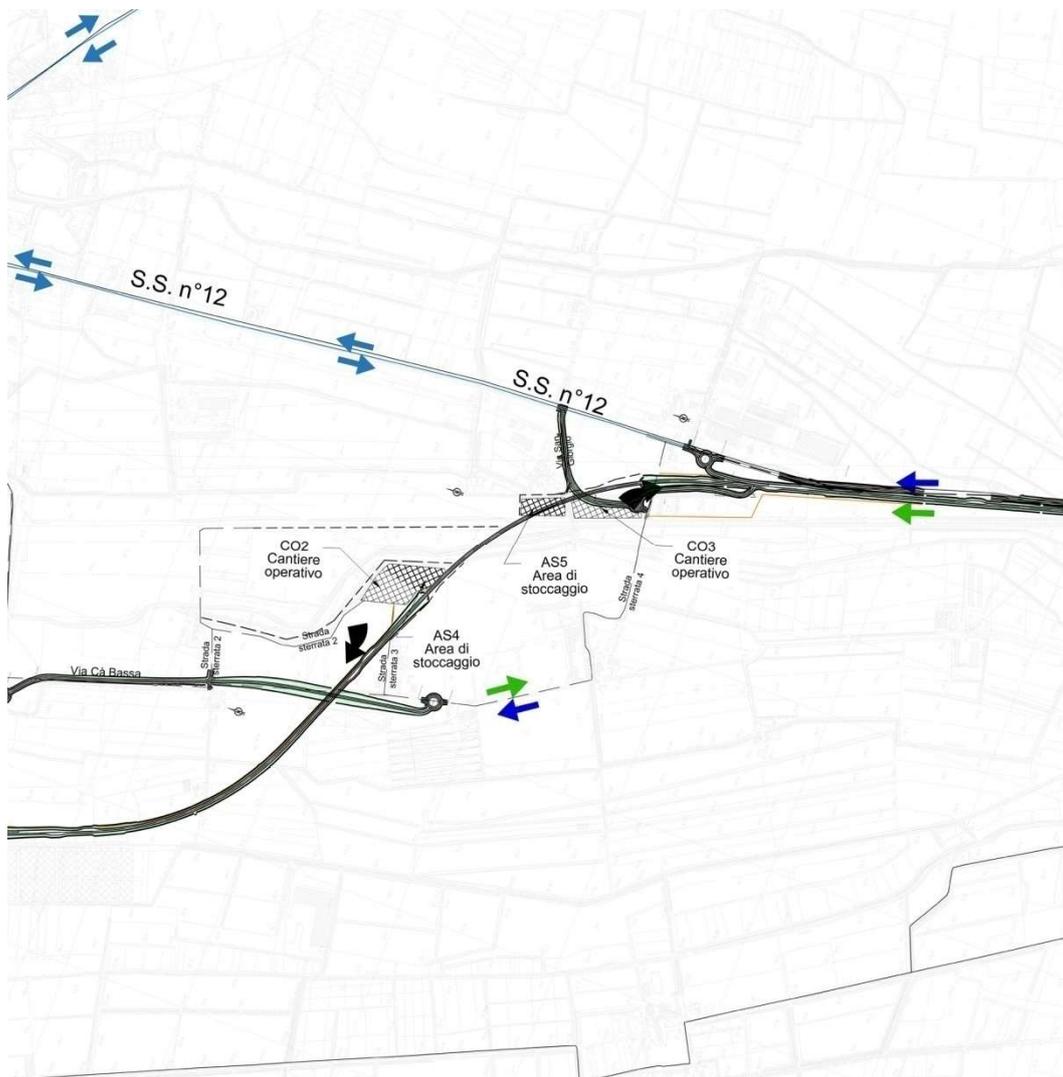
Stralcio 21-004_T00CA00CANPL02_A – Planimetria aree e viabilità di cantiere
